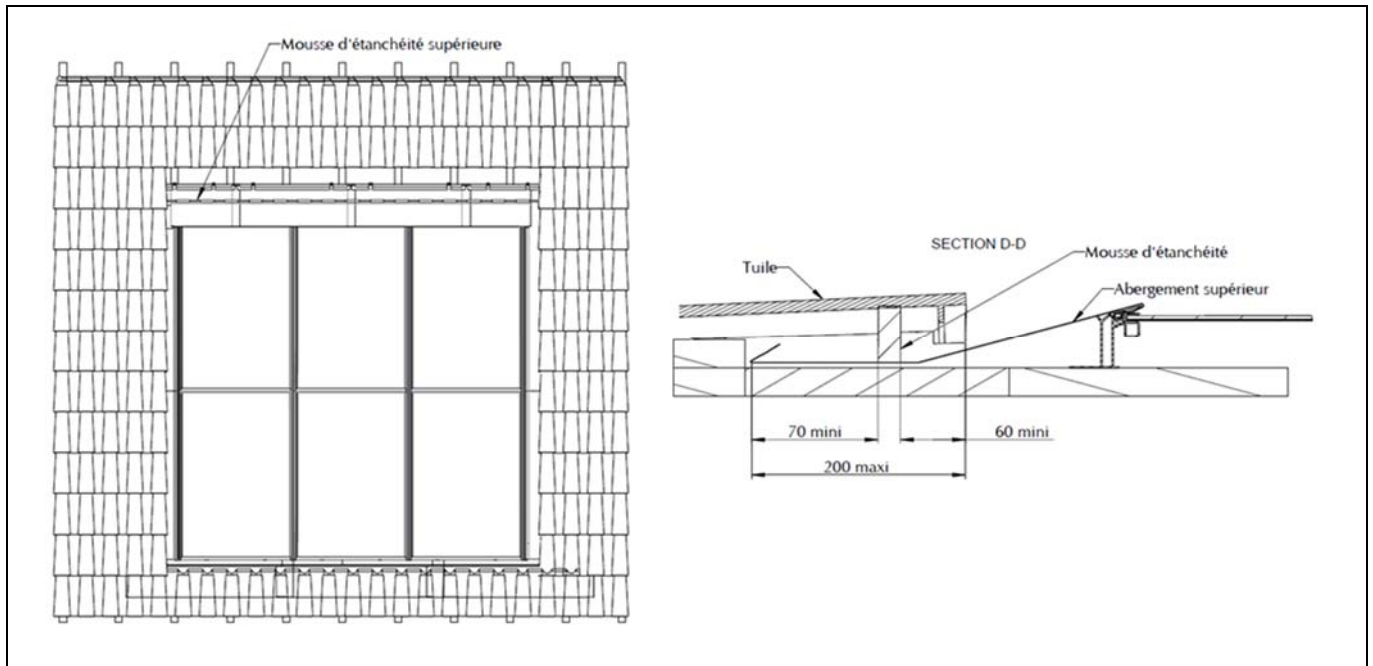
Pose des barrières « T » pour installation sur toiture tuile
